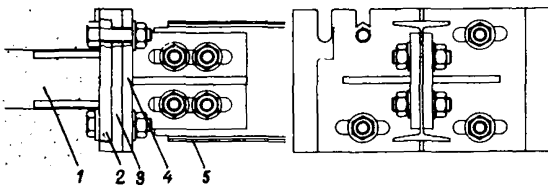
Конструкция регулируемой опоры для крепления расстрелов при широкой регулировке в двух направлениях: 1 - консоль; 2 - опорный лист; 3 - накладка; 4 - уголки; 5 - расстрел
